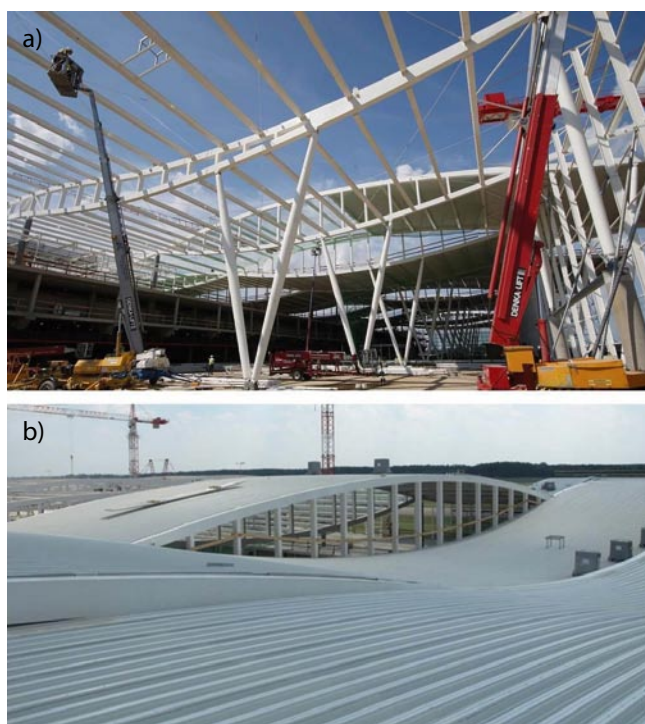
Konstrukcja zadaszenia hali widowiskowo-sportowej w Biłgoraju – opis w tekście
